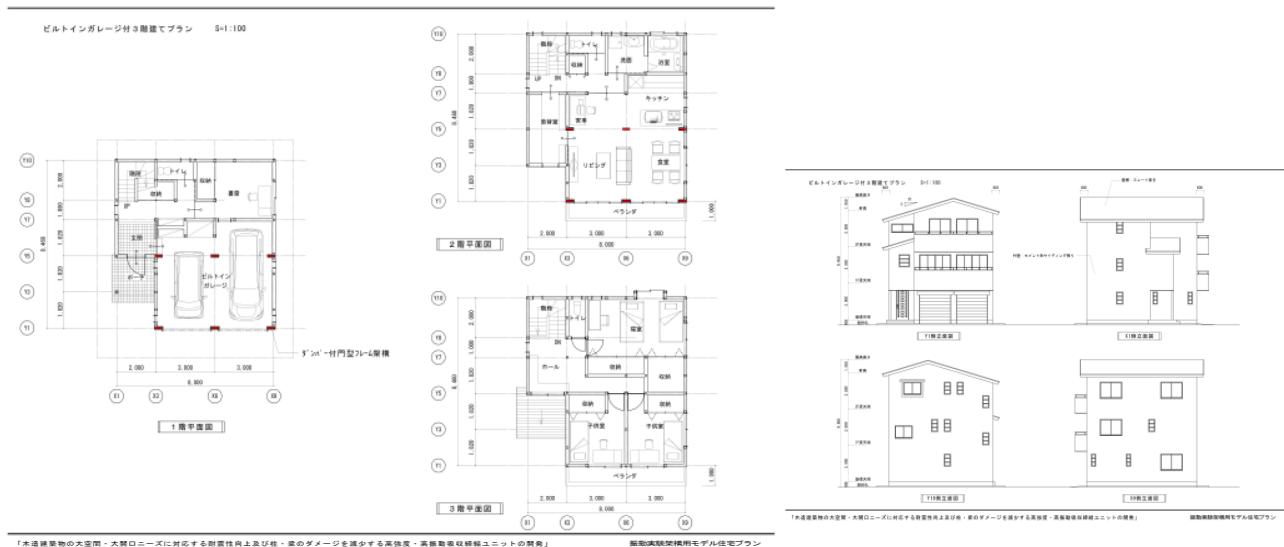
作成したモデル住宅プラン 平面図・立面図
